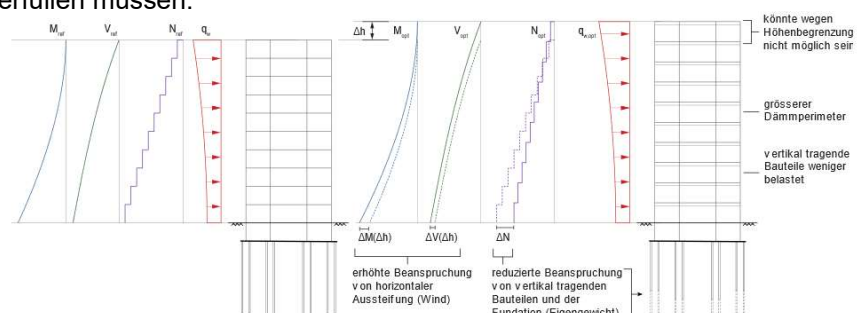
Indirekte Einflüsse leichter Konstruktionen mit grösserer Konstruktionshöhe: Vergleich zweier Bauweisen mit massiven Flachdecken (links) resp. leichten, aber eine grössere Bauhöhe erfordernden Geschossdecken.
